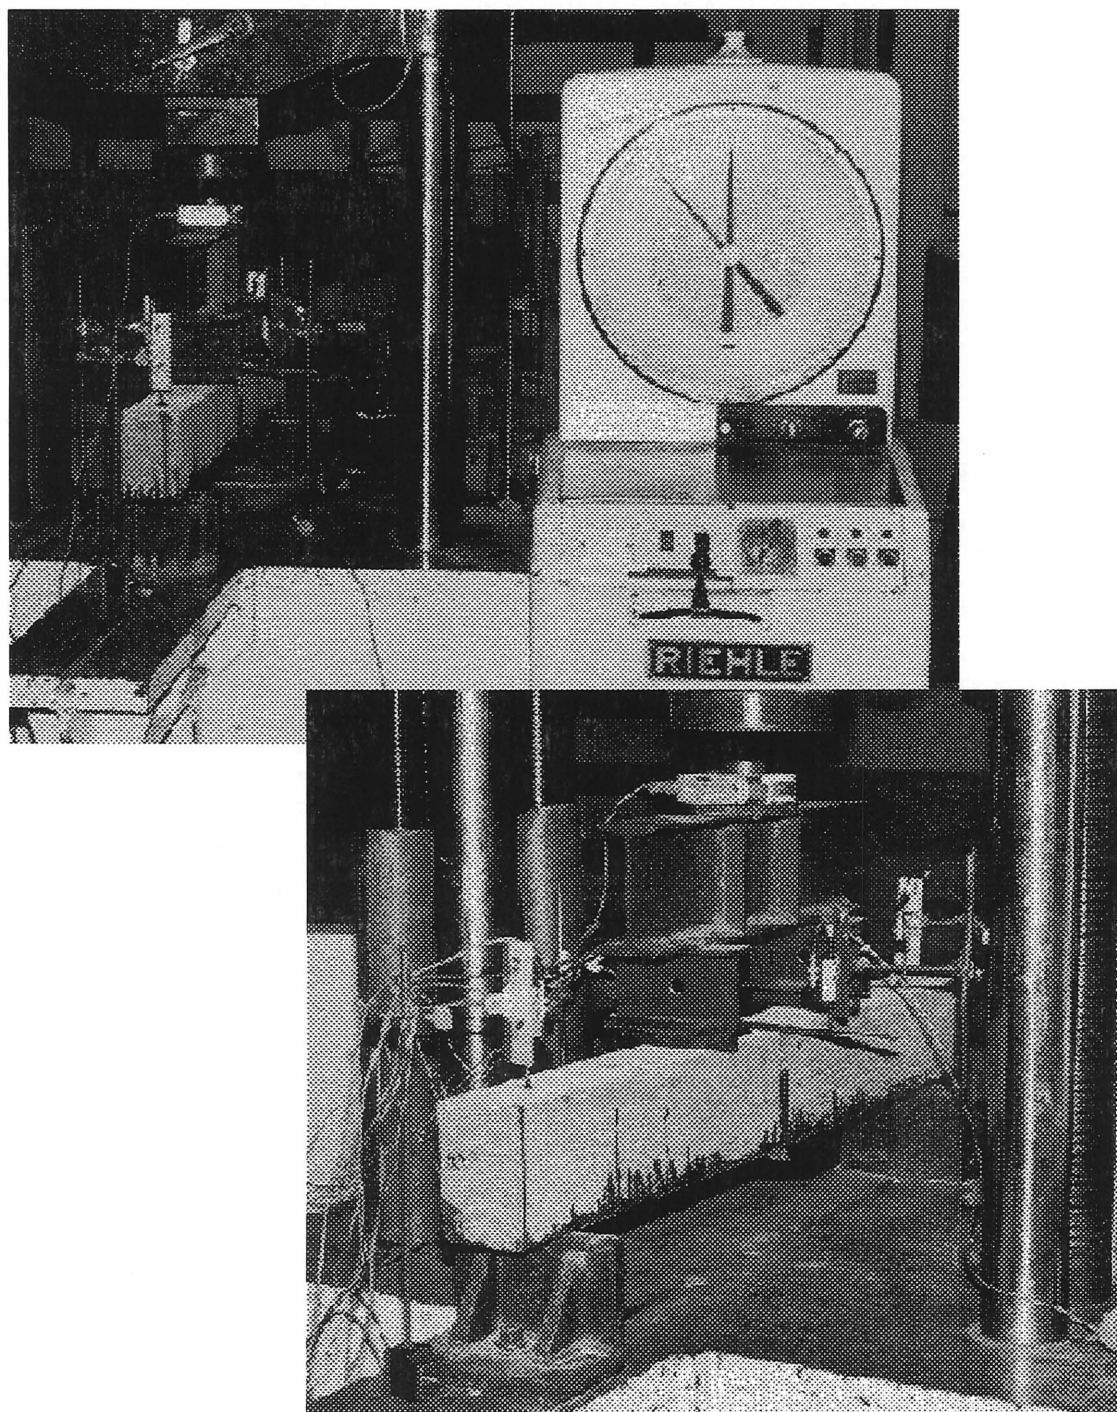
Montage d'essais sur les poutres après le gel-dégel
